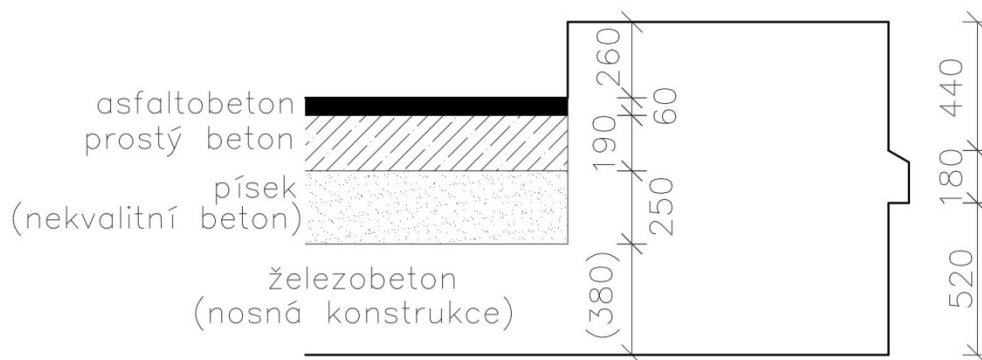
Detail vrtu 04-V5 po odvrtání – asfaltový beton a betonová vrstva.
